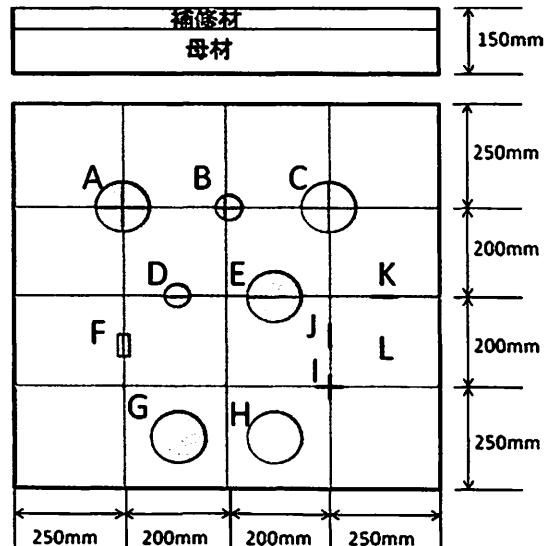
供試体の寸法・欠陥、鉄筋の配置図
